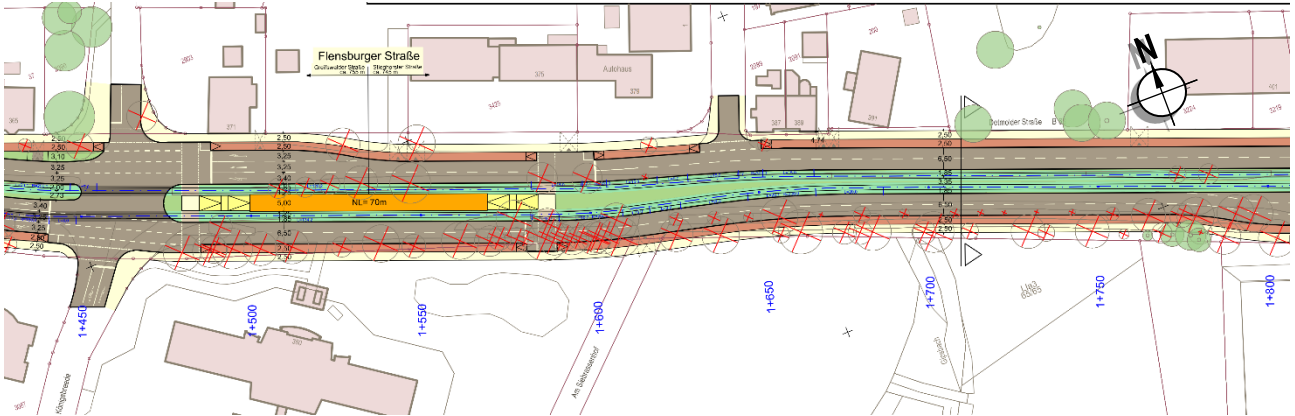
Trassenvariante 1 – Lageplan Detmolder Straße Haltestelle Flensburger Straße
